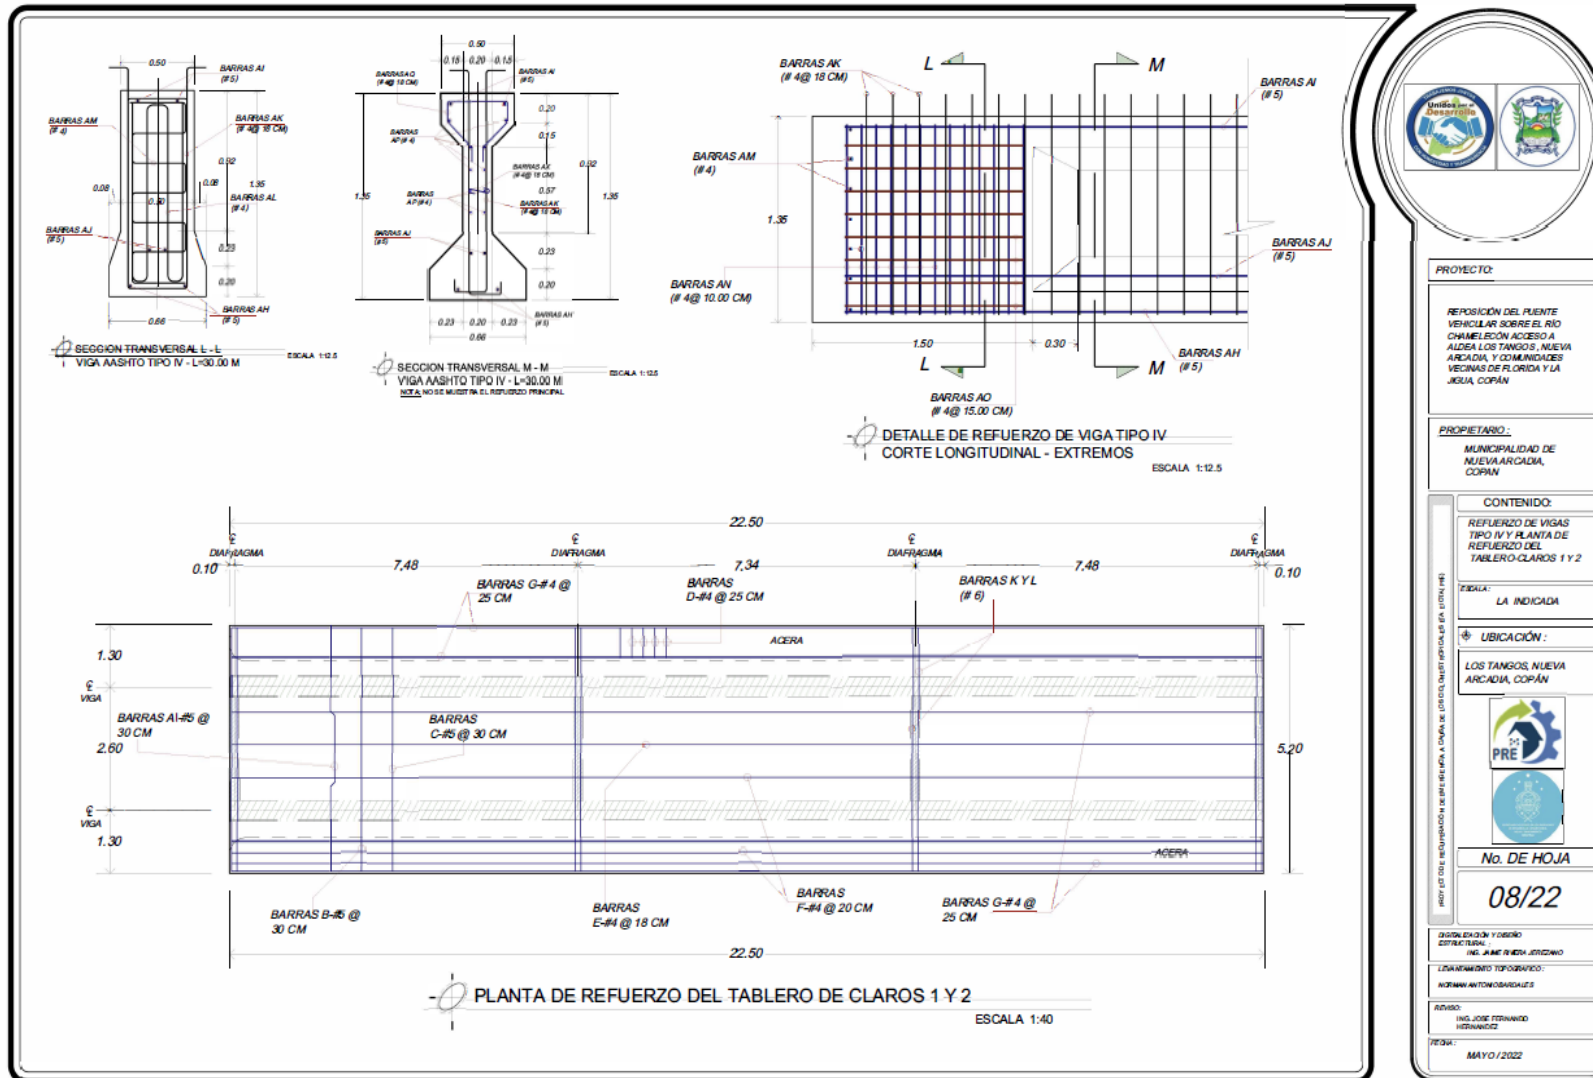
Planta refuerzo de vigas y planta de refuerzo de tablero claros 1 y 2
